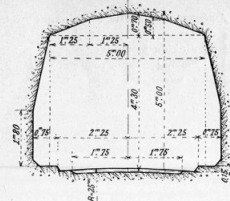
Coupe transversale d'un tunnel en roche dure.
